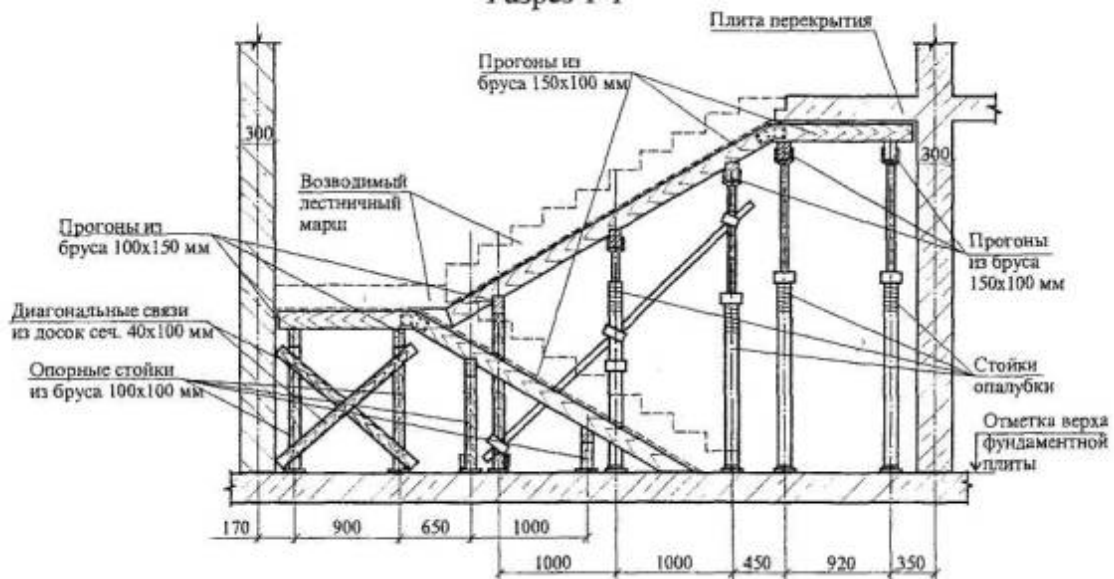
Схема расстановки опорных стоек и раскладки опорных брусьев в продольном и поперечном направлениях
